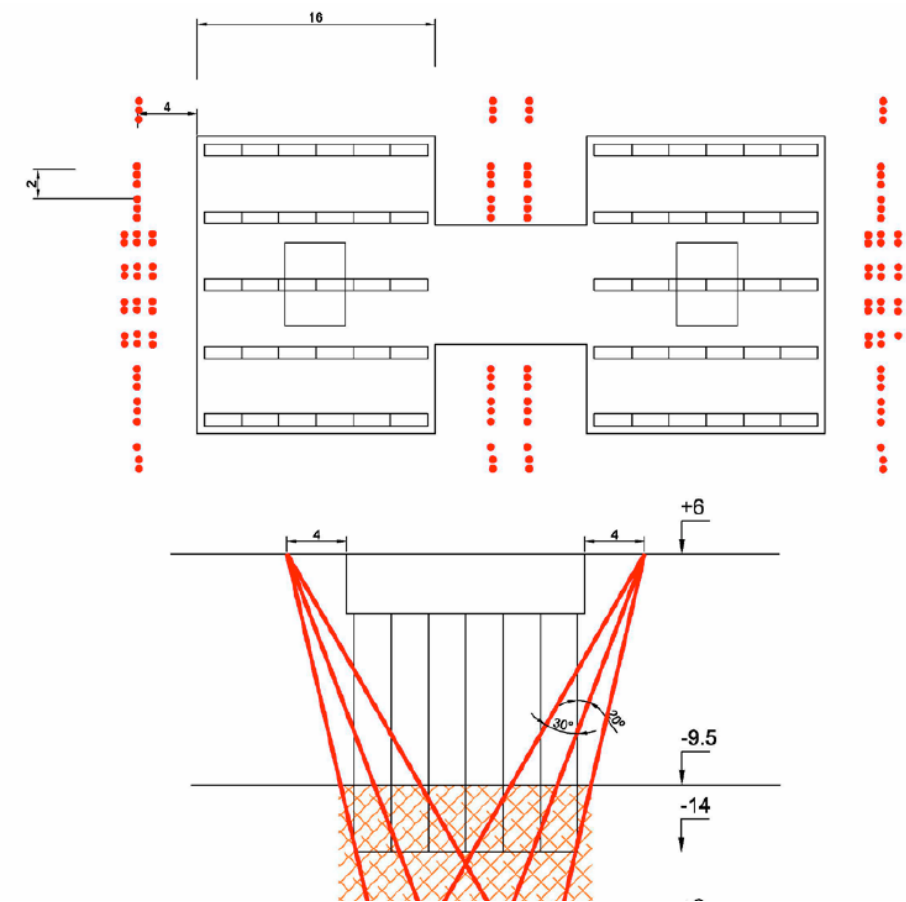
Tratamiento de inyecciones del terreno bajo cimentación de pilonos
